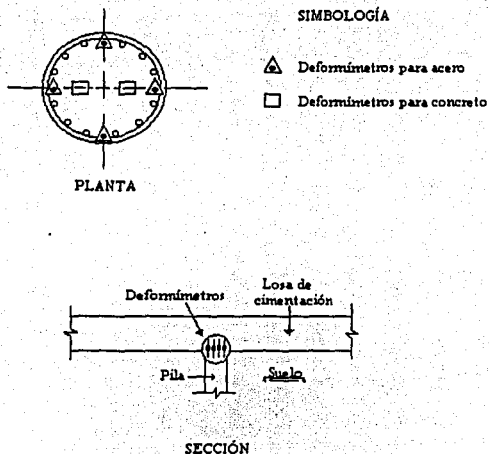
Esquema de las pilas instrumentadas en la cabeza.
